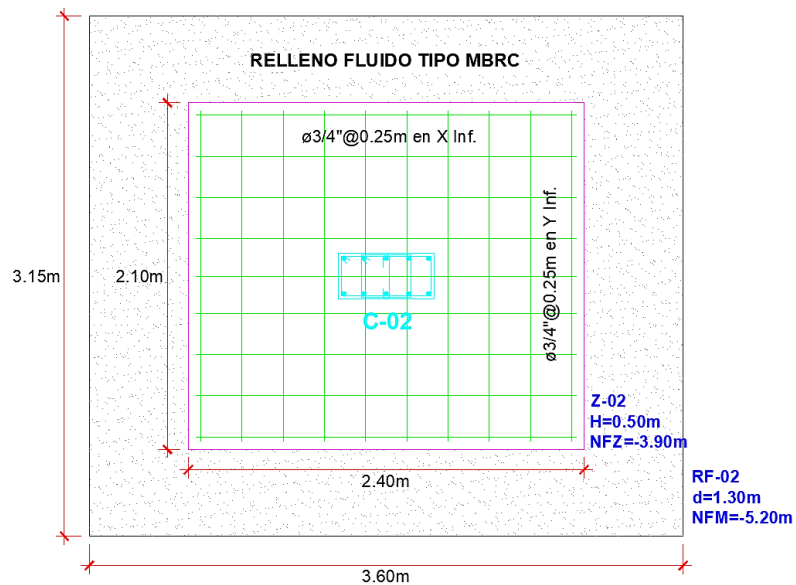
Detalle del mejoramiento de suelos con relleno fluido de la zapata aislada vista en planta
